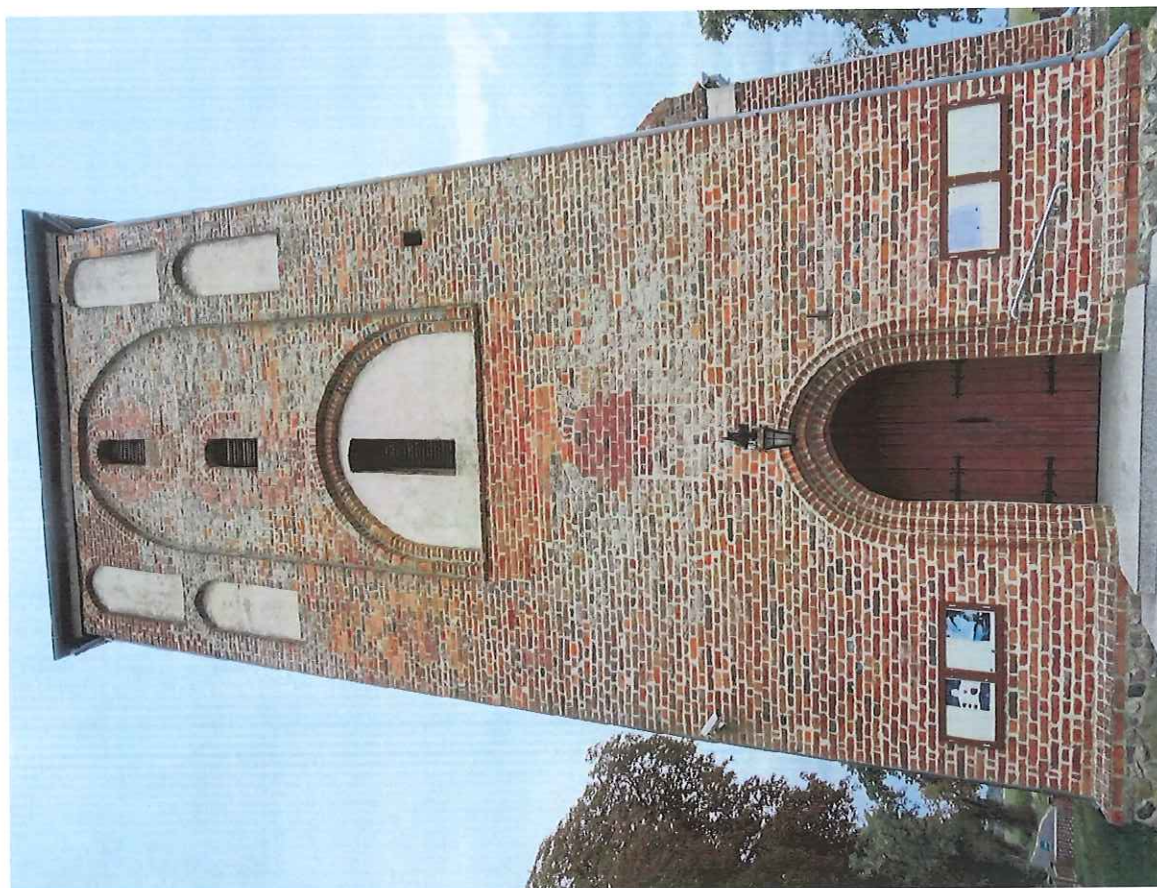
Elewacja południowa wieży kościoła p.w. św. Jakuba Apostoła w Żmijewie, sierpień 2023 r.
